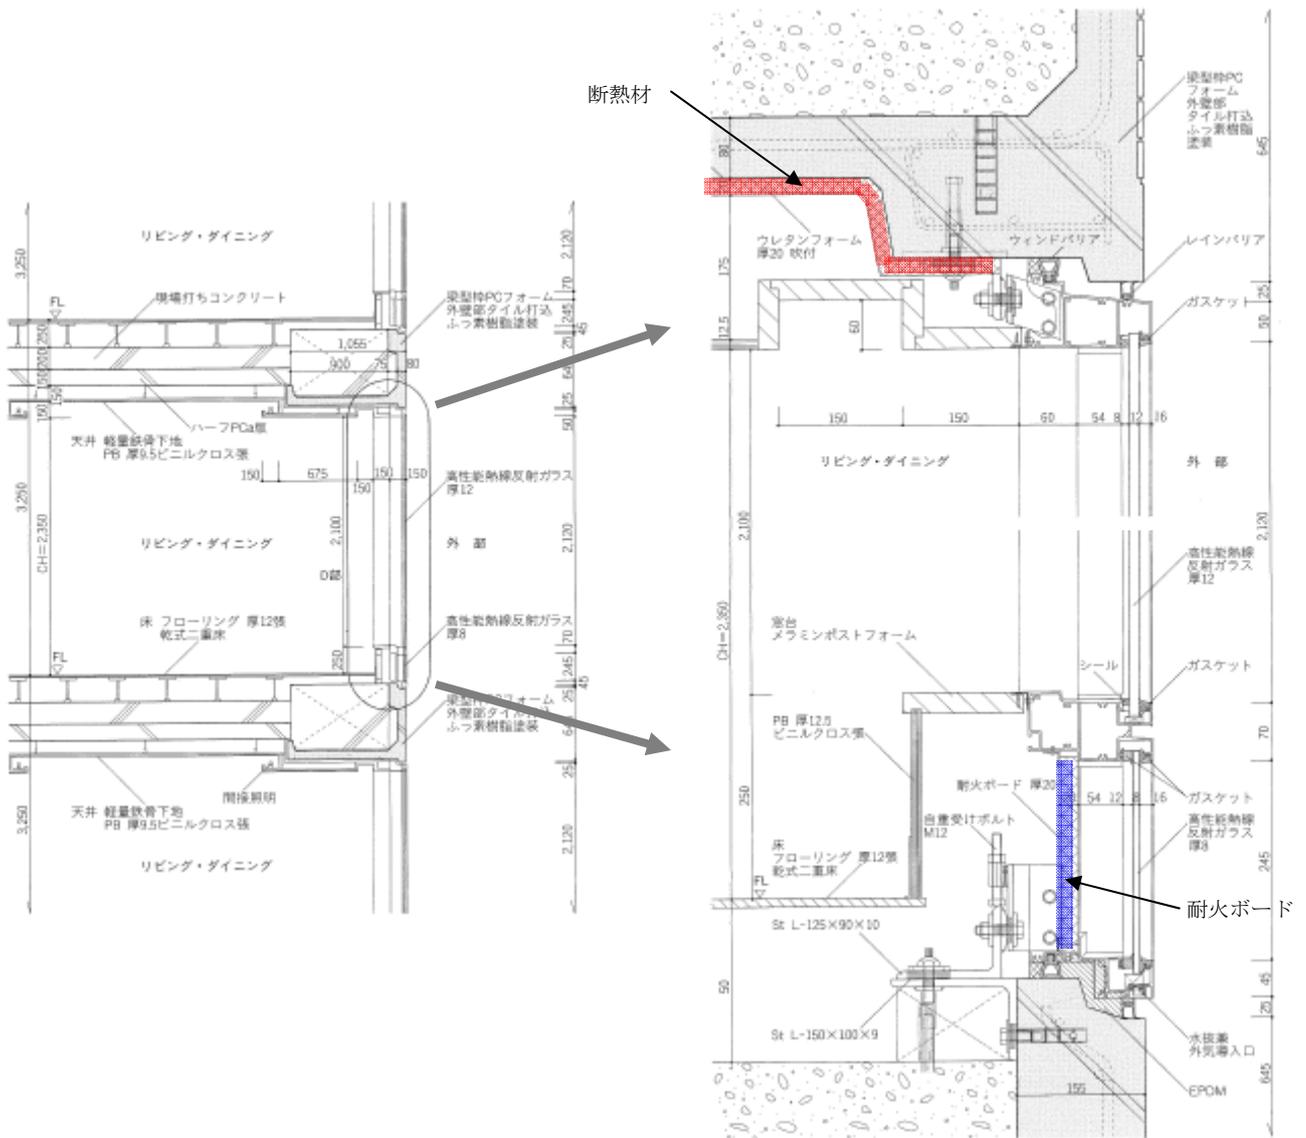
TOKYO TIMES TOWER図面 (断面)
